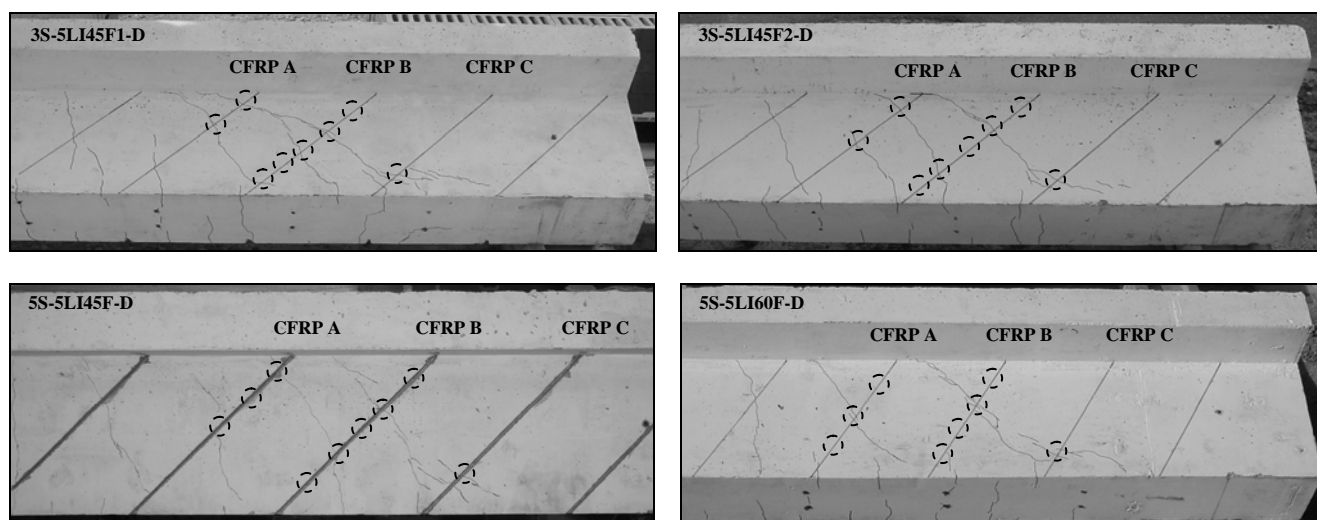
Localização das secções dos laminados onde foram colados os extensómetros eléctricos nas vigas pré-fendilhadas.
